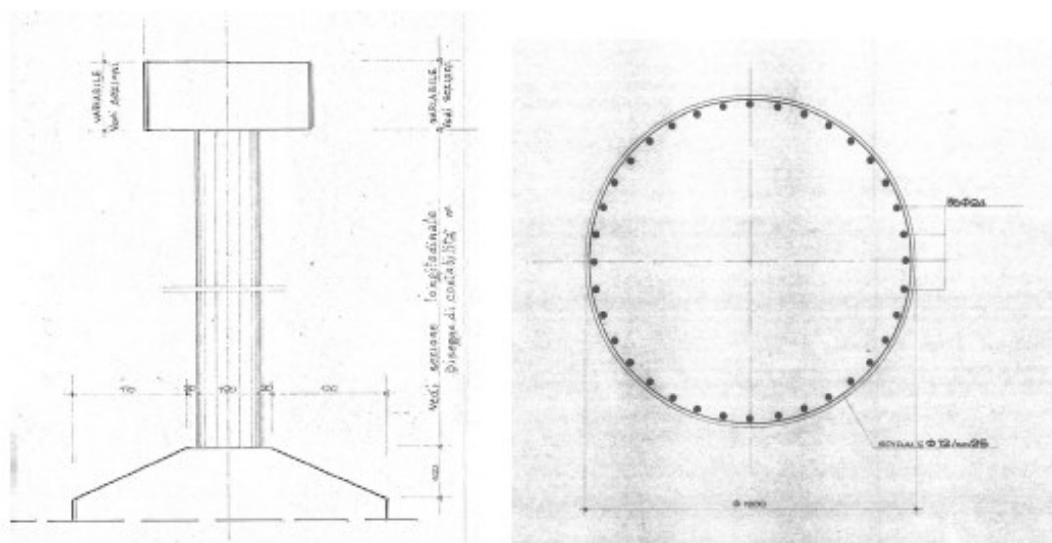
Prospetto longitudinale della pila e sezione del fusto tipo
